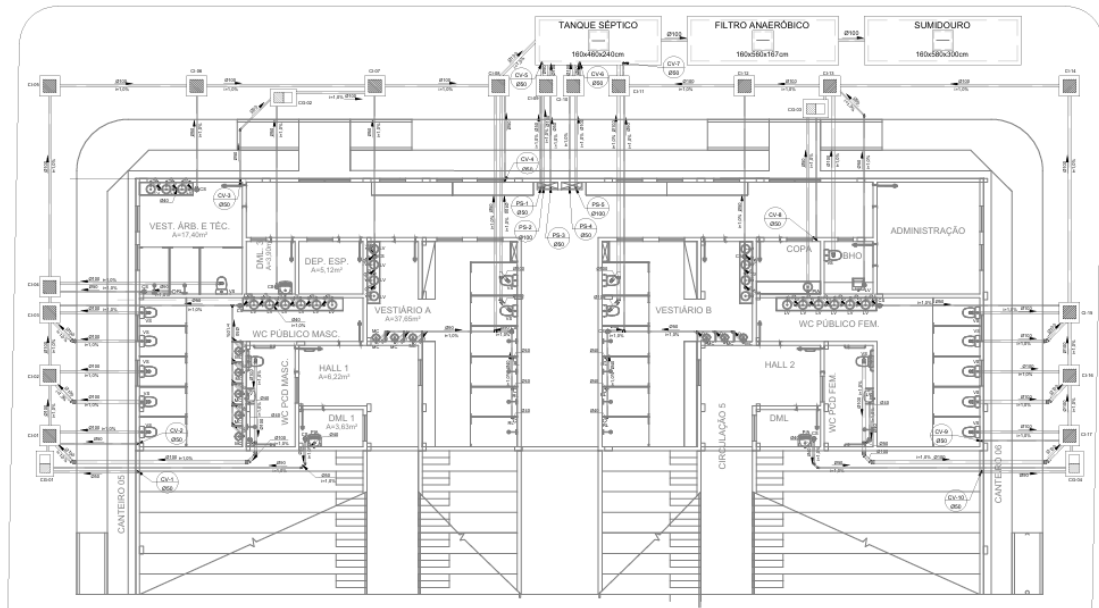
Instalações Hidrossanitárias do Pavimento Térreo
